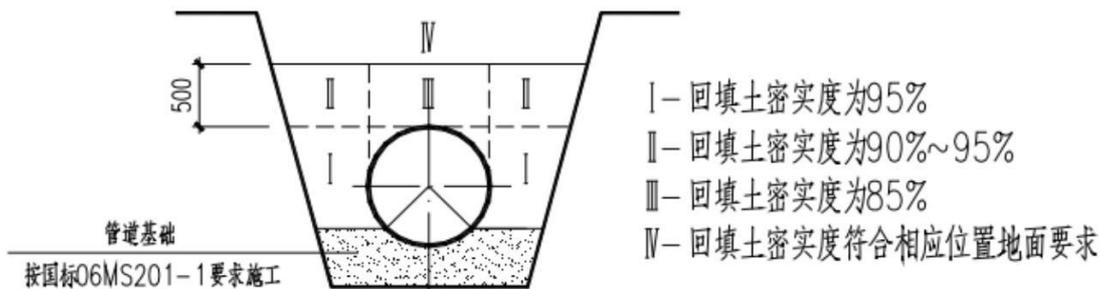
用于钢筋混凝土管道 (不含道路下埋深小于 700)
